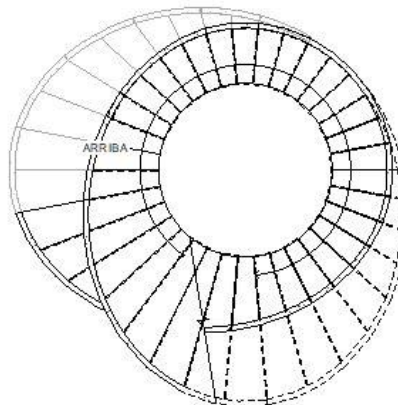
Tercer tramo de la escalera (Vista de planta Nivel 3)
